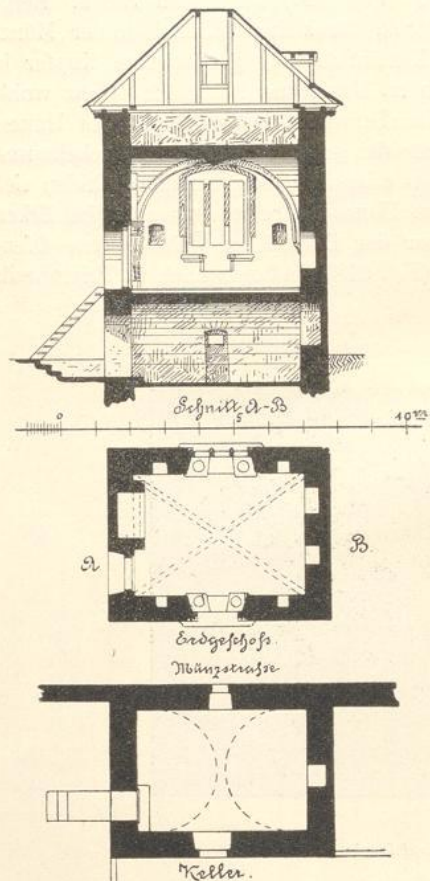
321. Goslar, Zimmer in der Münzstrasse; Schnitt und Grundrisse.
